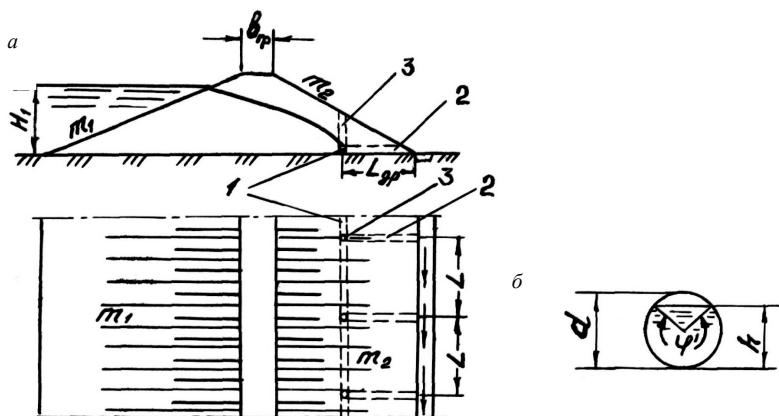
Внутренний трубчатый дренаж: *a* – размещение смотровых колодцев; *б* – расчетная схема безнапорной трубы; 1 – продольные дрены; 2 – поперечные дрены; 3 – смотровые колодцы
